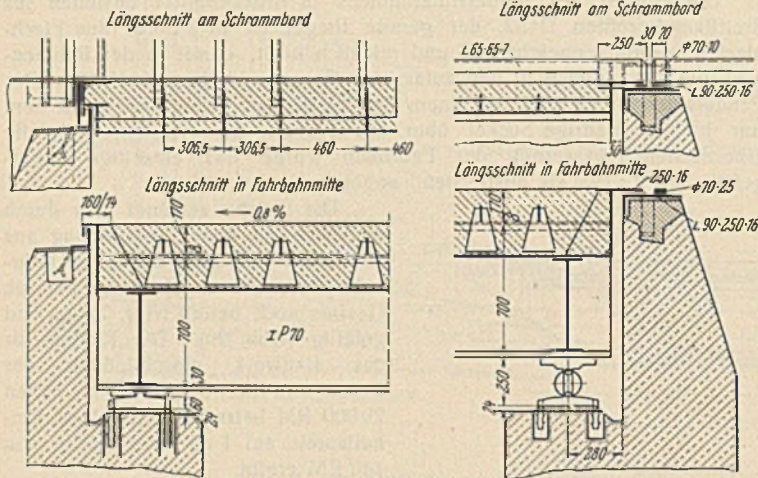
Fahrbahnübergang am festen und beweglichen Lager.
